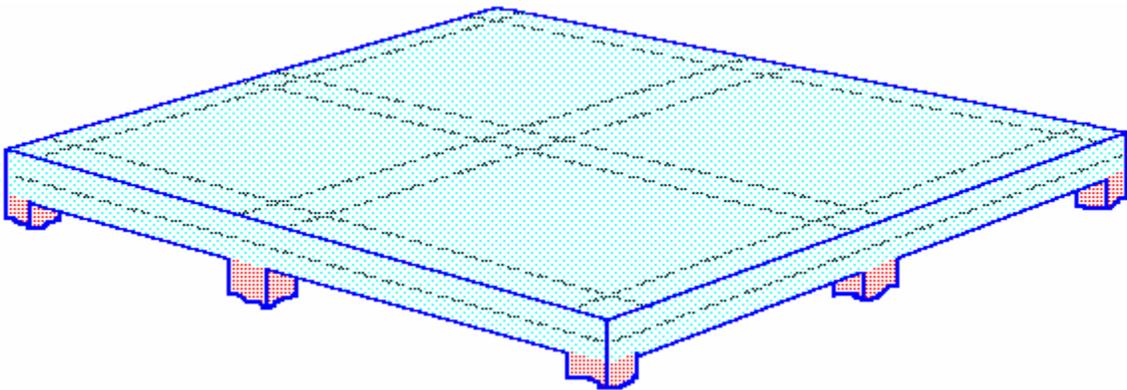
(a) Vista de la estructura de cubierta.
